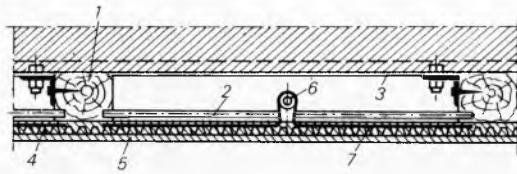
Stropno grijanje sa grijaćim cjevima ispod rebraste stropne konstrukcije. 1 armirani beton, 2 izolacija, 3 cjevni registri, 4 betonski sloj, 5 nosiva konstrukcija za cjevne registre, 6 čelična mreža, 7 žbuka
